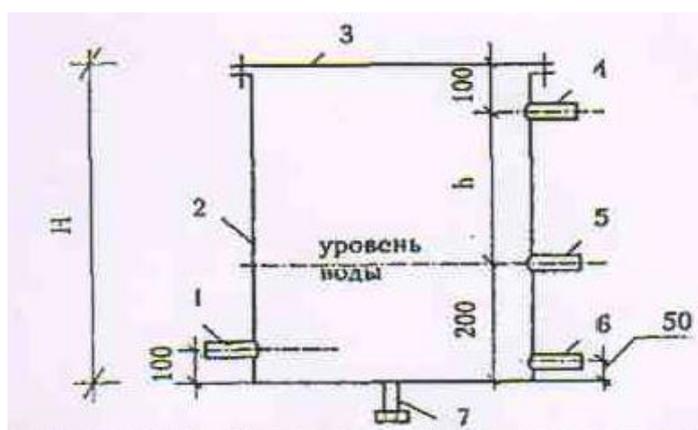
Устройство расширительного бака системы водяного отопления (размеры в мм): 1 - расширительный (входной) патрубок; 2 - корпус бака (нерж. сталь толщиной 1 мм); 3 - крышка бака; 4 - переливной патрубок (соединен шлангом с воронкой сливной магистрали, соединение негерметично, что обеспечивает связь с атмосферой); 5 – сигнальный патрубок (соединен с сигнальной трубой); 6 - циркуляционный патрубок (из него вода поступает в циркуляционный контур); 7 - сливной штуцер с пробкой.
